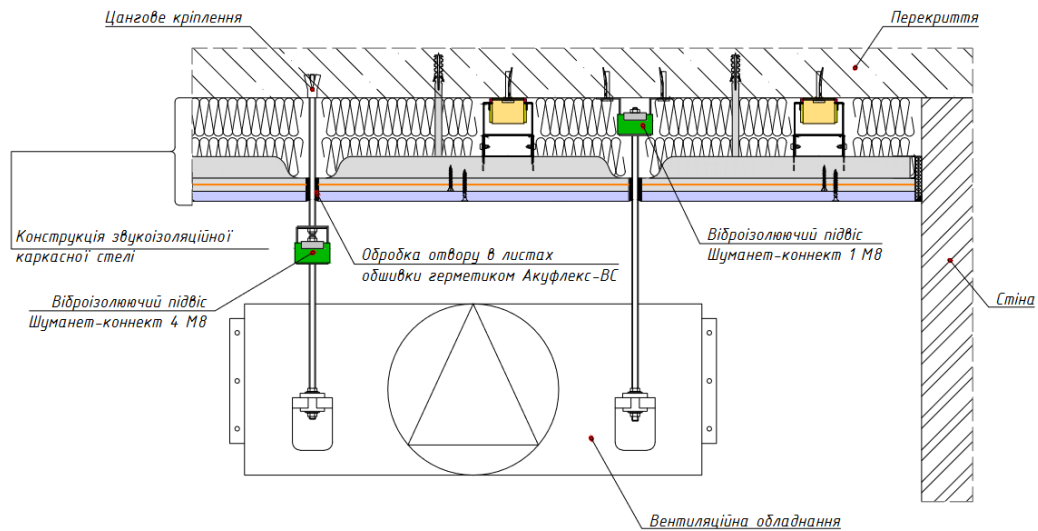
Схема монтажу вентиляційного встановлення до перекрыття
